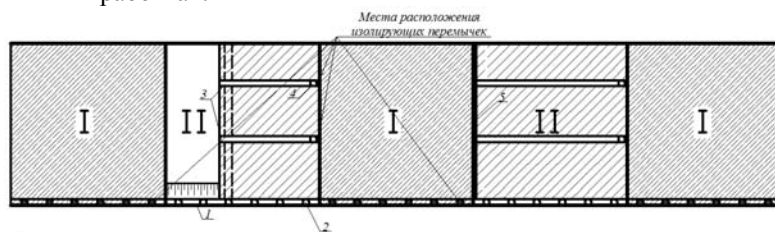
Схема расположения и порядок отработки камер I, II, очереди камерной системы разработки с твердеющей закладкой:
